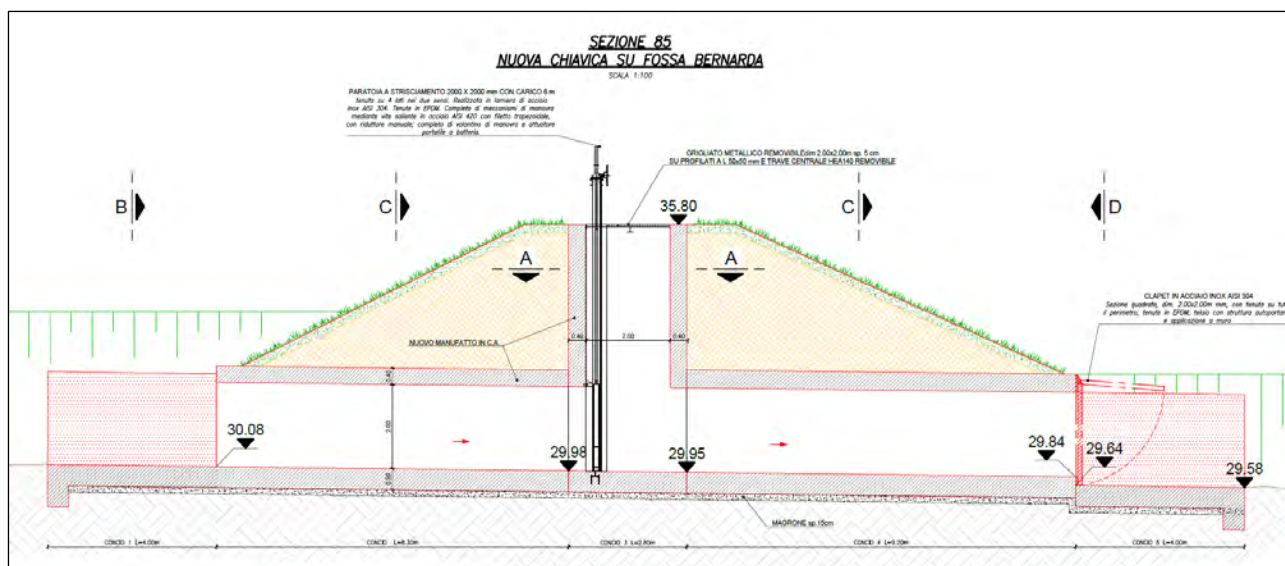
Sezione longitudinale manufatto su Fossa Bernarda
